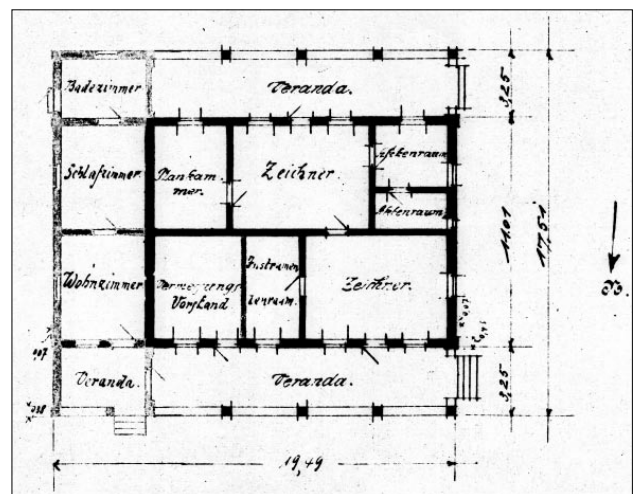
Grundriß des Erweiterungsbaus Omaruru, 1912 (NNA, BAU-107, Gebäudenachweisung Omaruru 1.4.1912)
